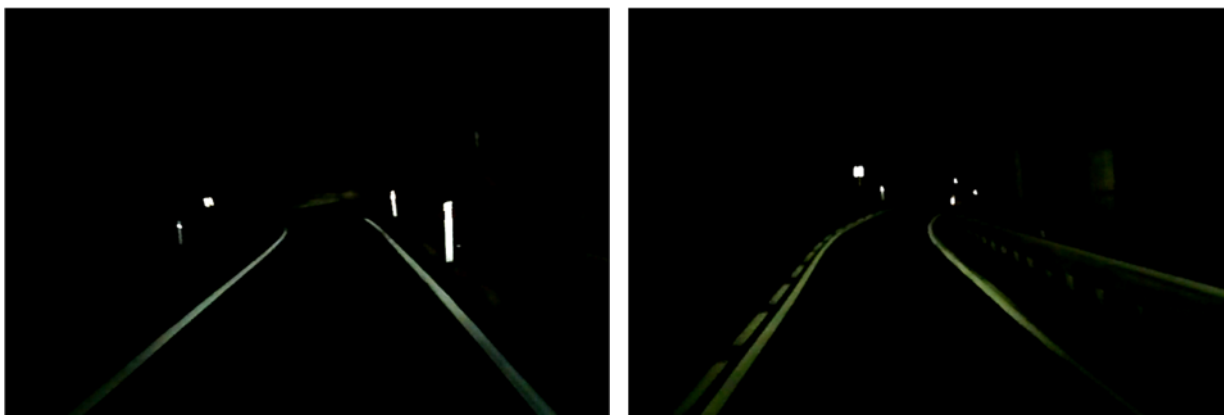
Pohled po směru staničení – konstrukce sjezdu tvoří pevnou překážku.
